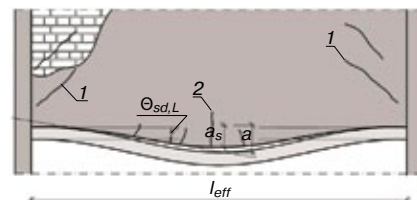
Схема деформирования перегородки, опирающейся на диски перекрытия: 1 – трещины, вызванные сдвигом кладки; 2 – трещины, вызванные изгибом перегородки в своей плоскости
